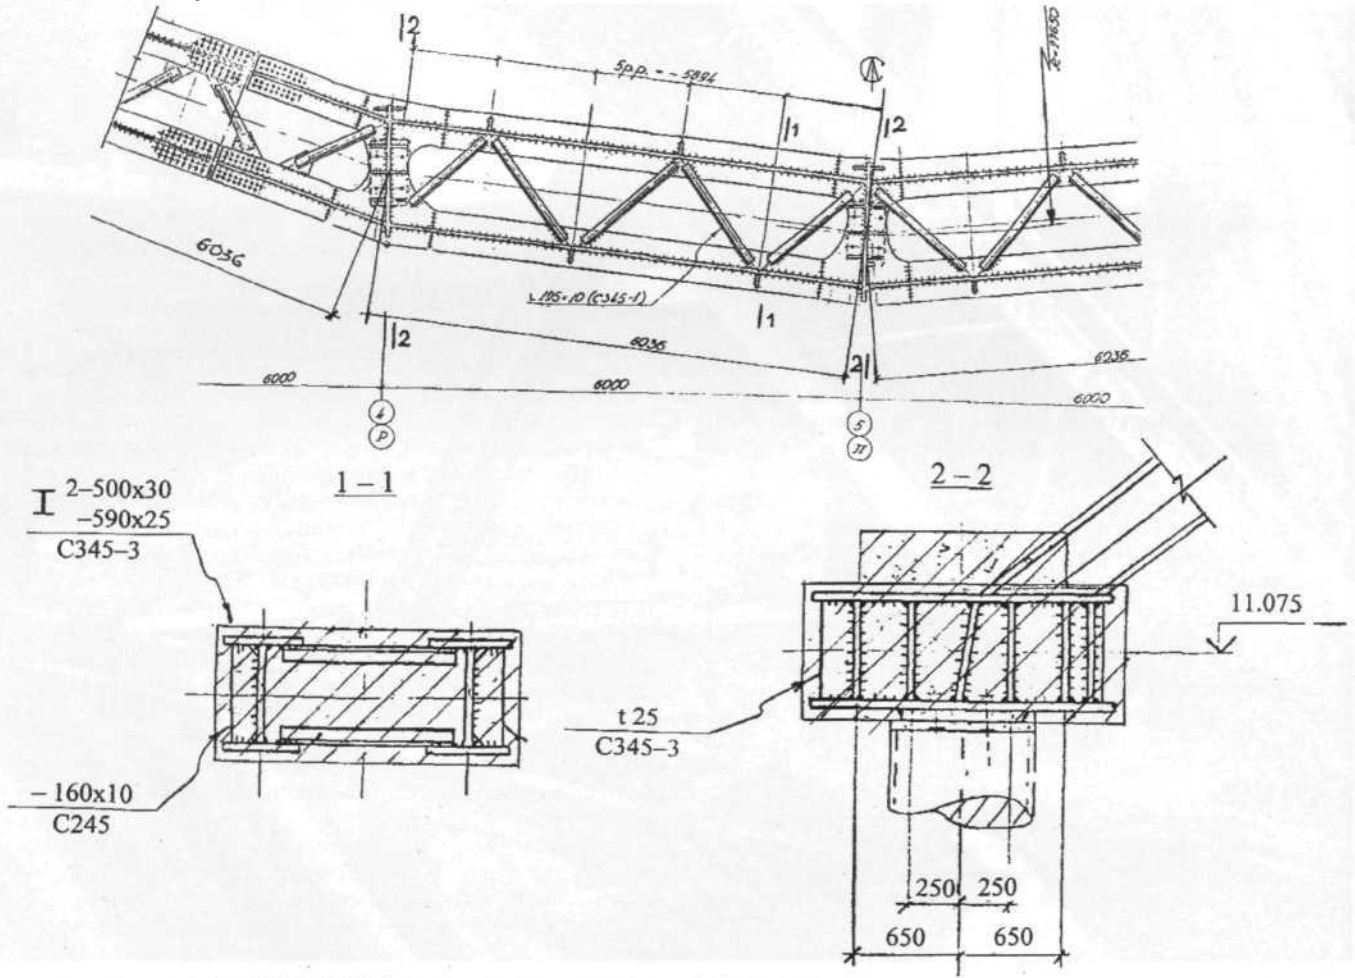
Схема расстановки песчаных домкратов на опорном кольце на отметке 12,6 м
